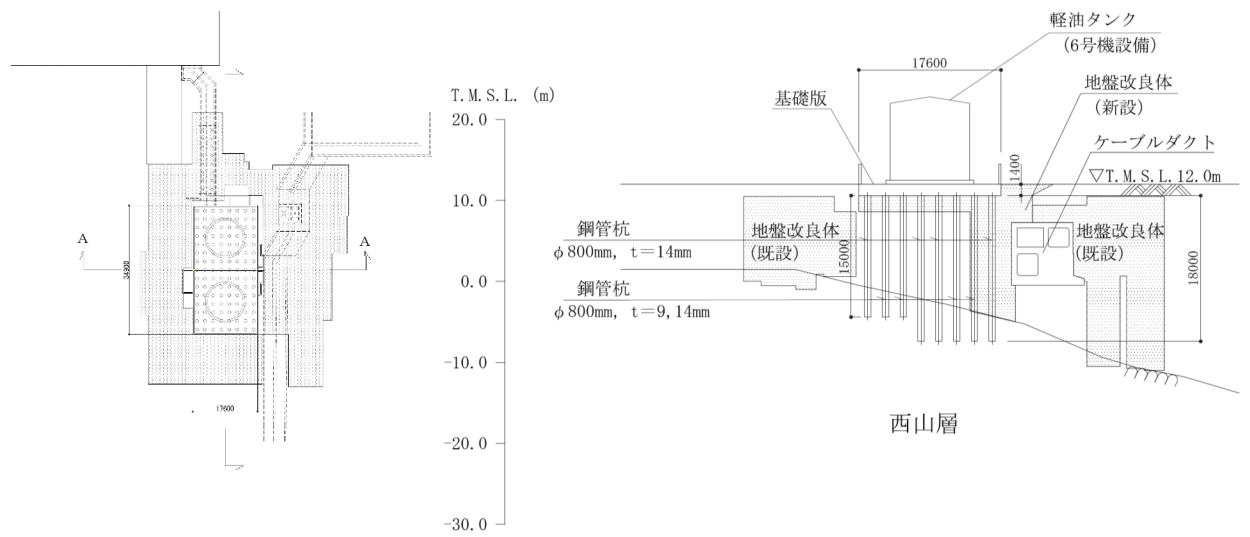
軽油タンク基礎 (6号機設備) の断面図 (A-A断面)
